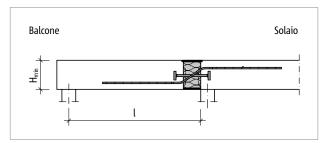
Schöck Isokorb® XT tipo QP: schema statico
